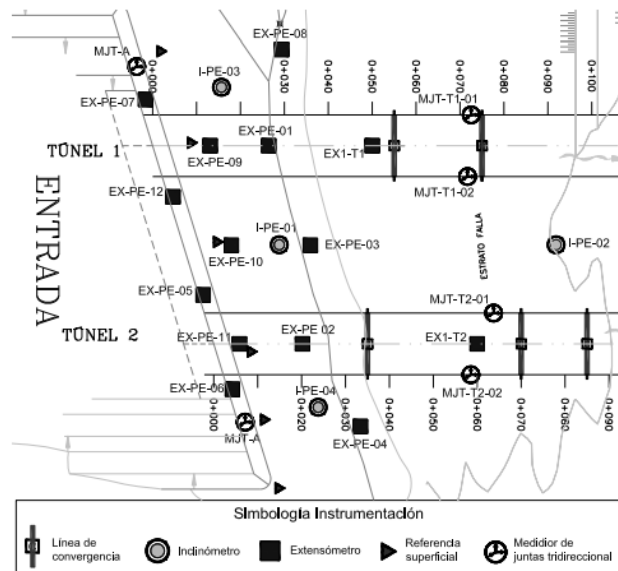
Localización en planta de los instrumentos en portales de entrada. Tomada de Diseño, instalación y puesta en servicio de la instrumentación de los túneles de conducción del río Grijalva, Chiapas. SMIG
